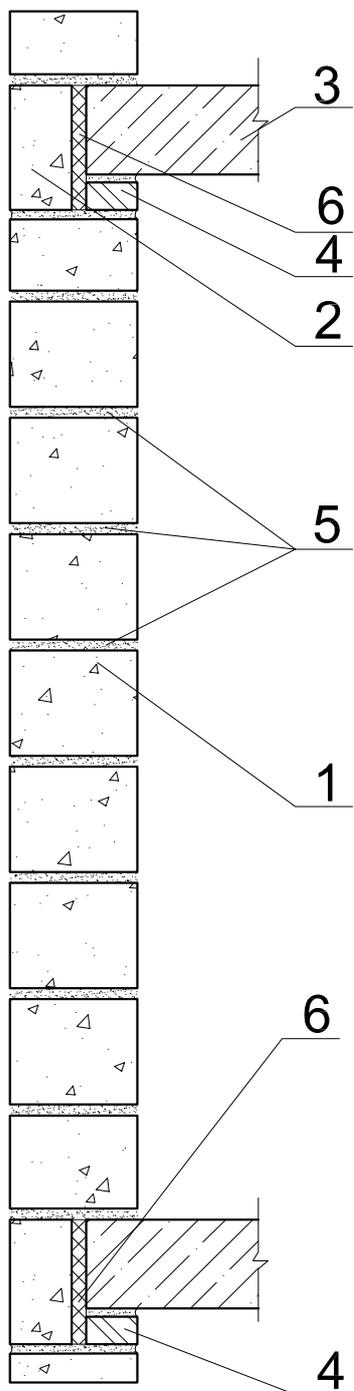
Газобетонная кладка самонесущей стены на монолитном ригеле (поясе) в составе перекрытия
